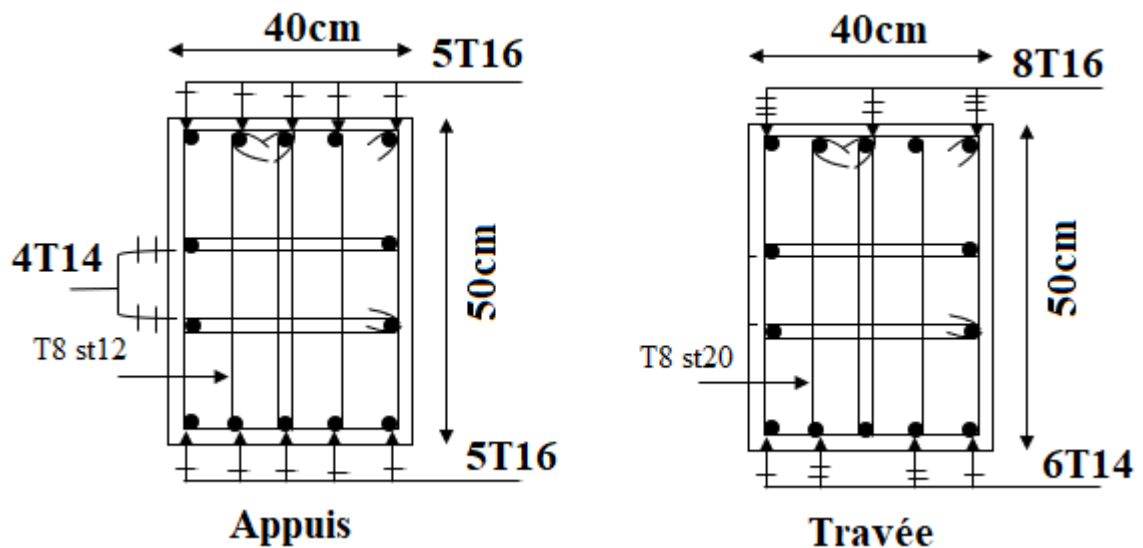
Ferraillage des poutres non porteuse (40x50) cm
